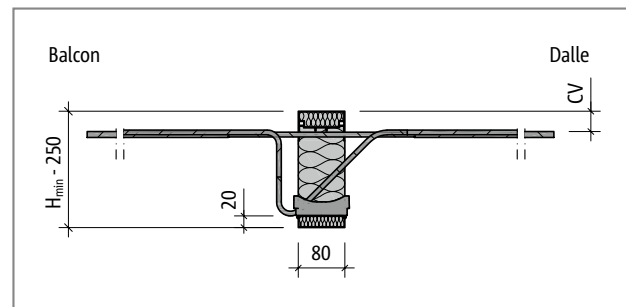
Schöck Isokorb® T Type K-E-M4 : Coupe du produit
